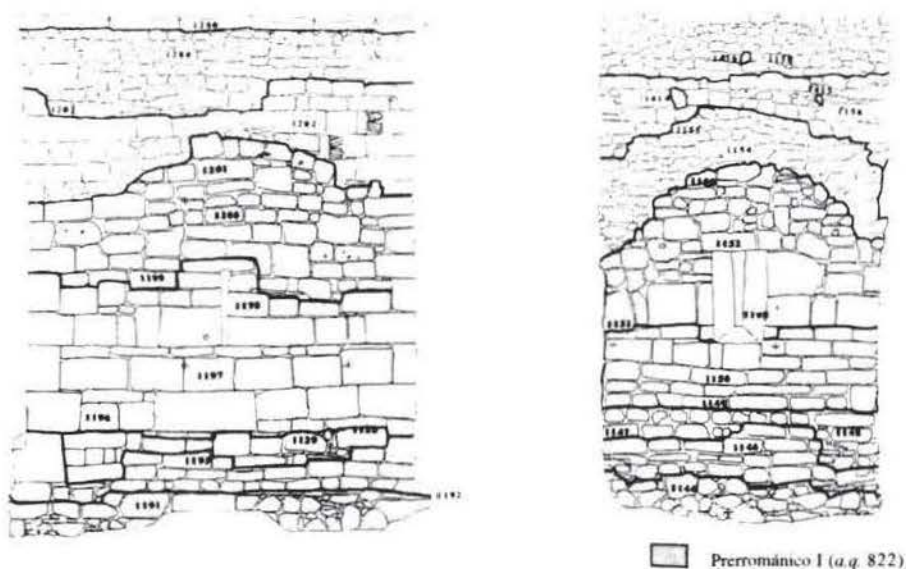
Alzado del ábside. Exterior e interior. Escala 1/100.
